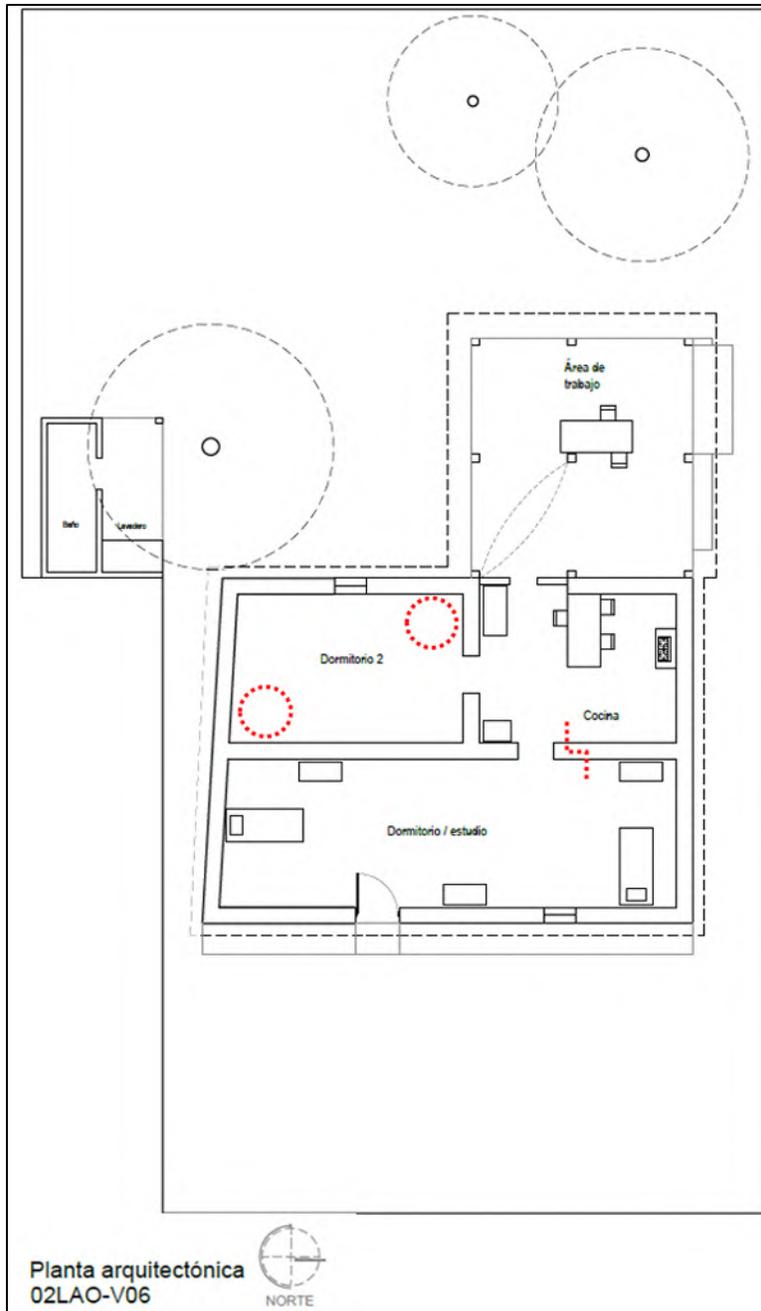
Planta arquitectónica. Estado actual, vivienda 02LAO-V06. Líneas punteadas en rojo representan agrietamientos. Círculos rojos refieren daños en cubiertas. Fuente: elaboración propia.
